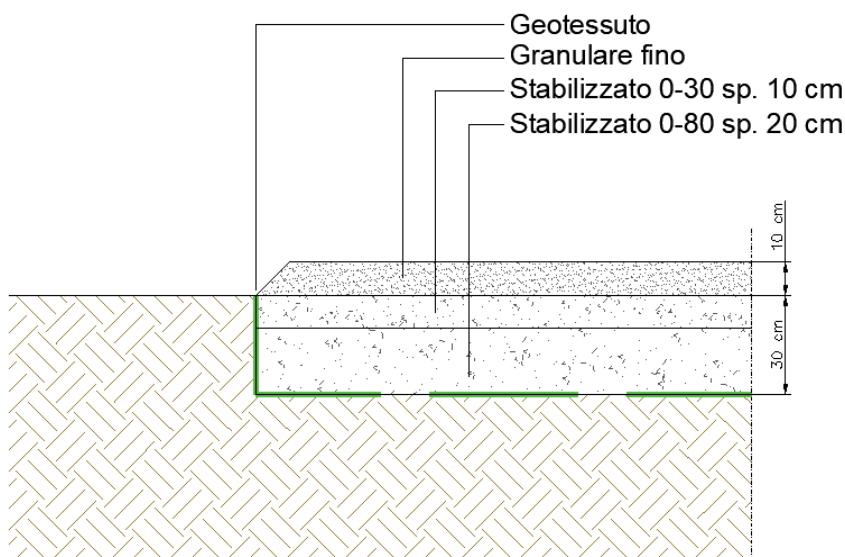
Sezione tipo viabilità interna all'impianto e piazzali
